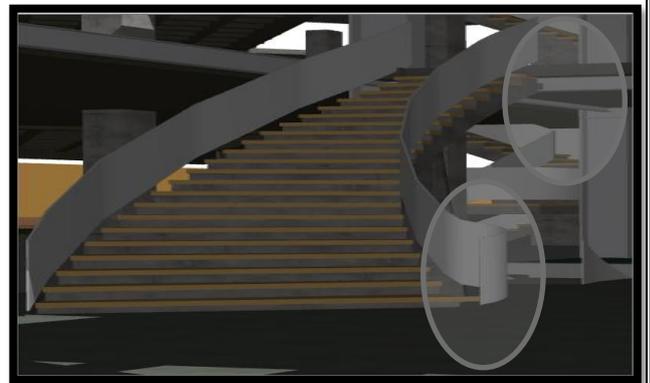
Détails d'assemblage escalier plate forme, escalier plancher
